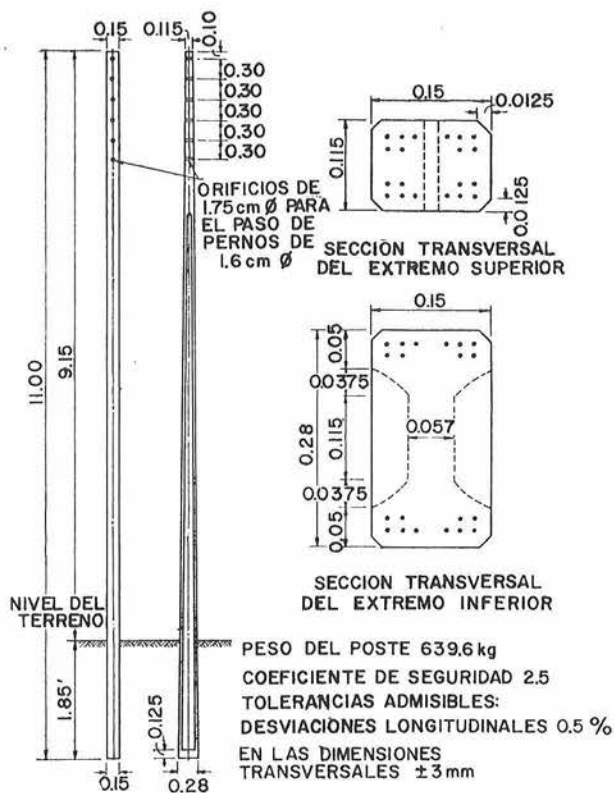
Detalle de uno de los postes de hormigón pretensado, de sección transversal en I, tipo 36/400.
